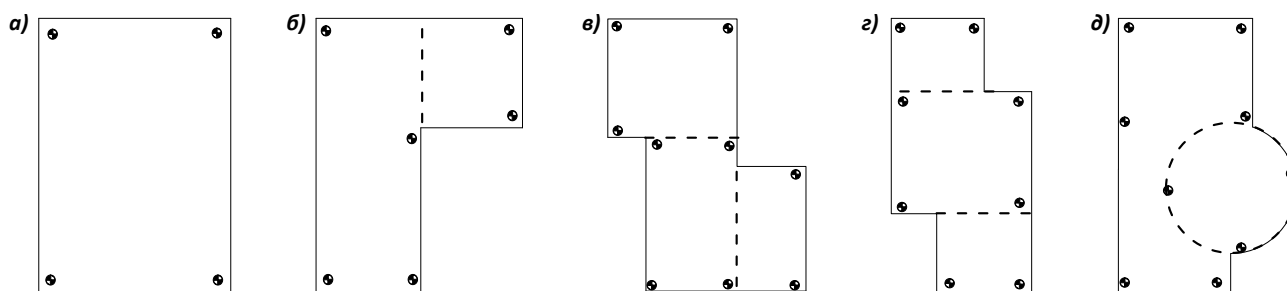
Основные формы монолитных железобетонных фундаментов с принципиальными схемами размещения деформационных марок
